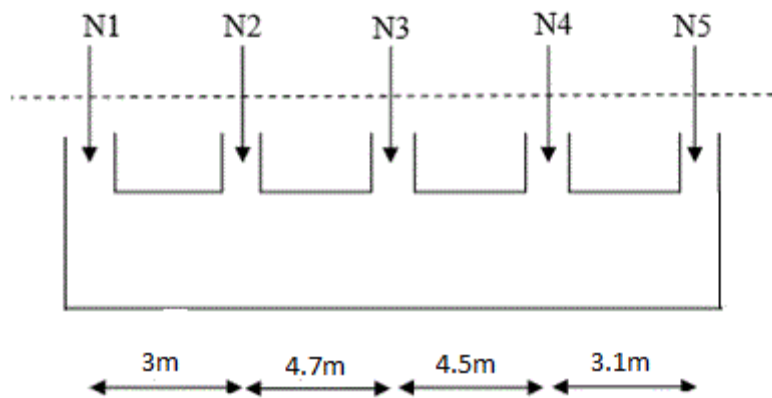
schéma statique d'une semelle filante suivant le sens y-y (file E) .
